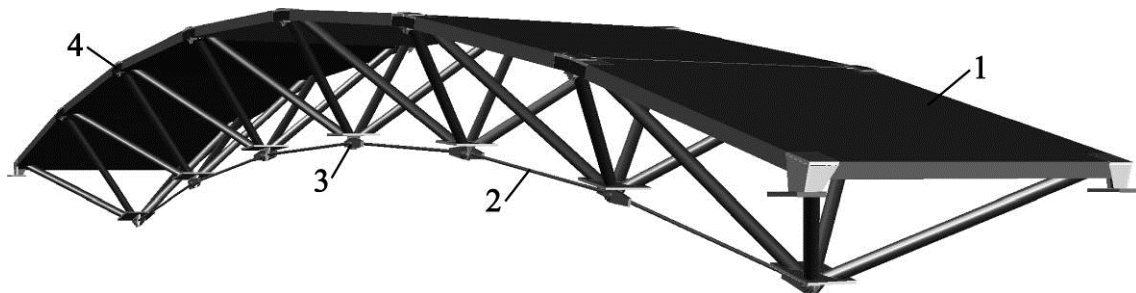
Фрагмент сталезалізобетонного структурно-вантового покриття / Part of steel and concrete composite grid-cable roof:
